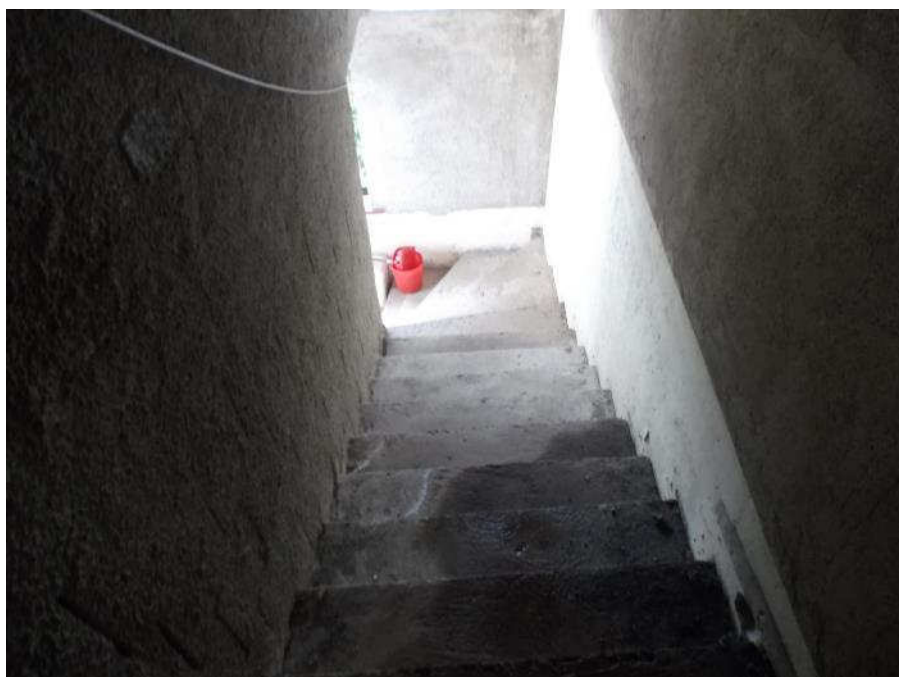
Scala di collegamento piano primo-piano sottotetto
